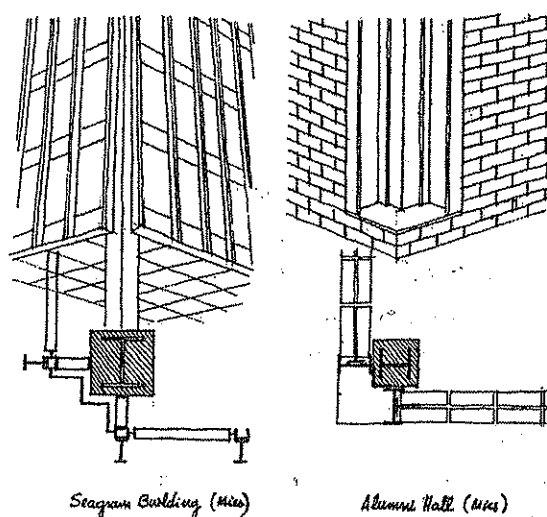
Detalle crítico Seagram Building y Alumni Hall - Mies
